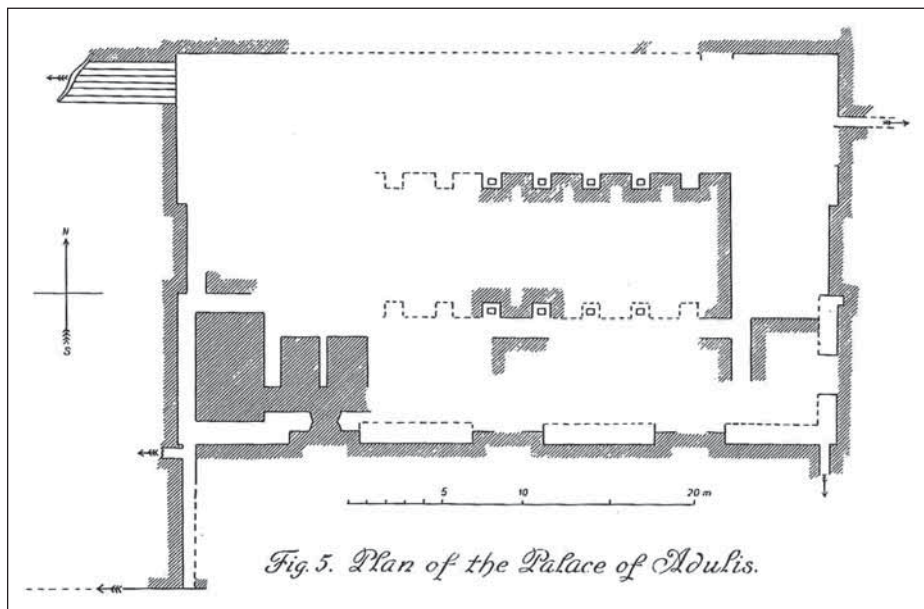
Adulis, planimetria dell’edificio scavato da R. Sundström (da SUNDSTRÖM 1907).
